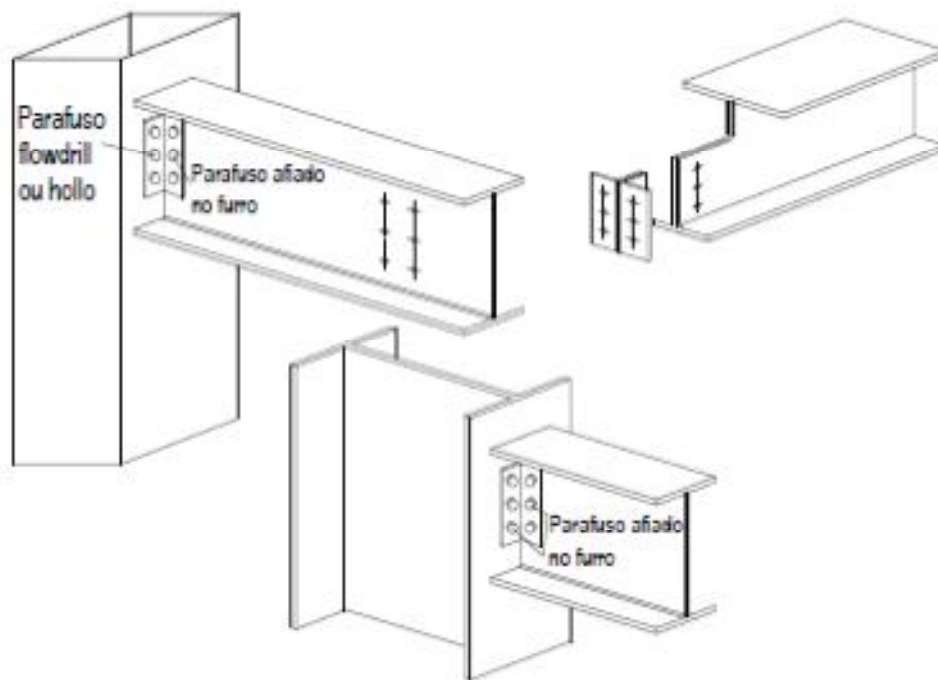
Ligação com cantoneira: Ligação viga-coluna e viga-viga
